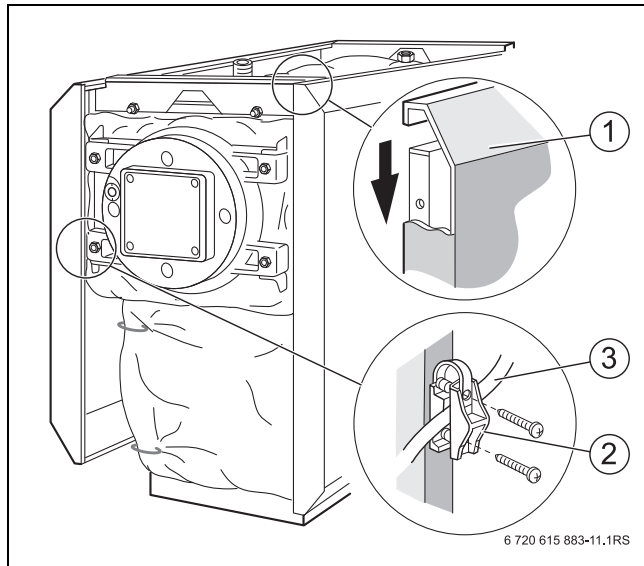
Seitenwände einhängen und Brennerkabel anbringen
